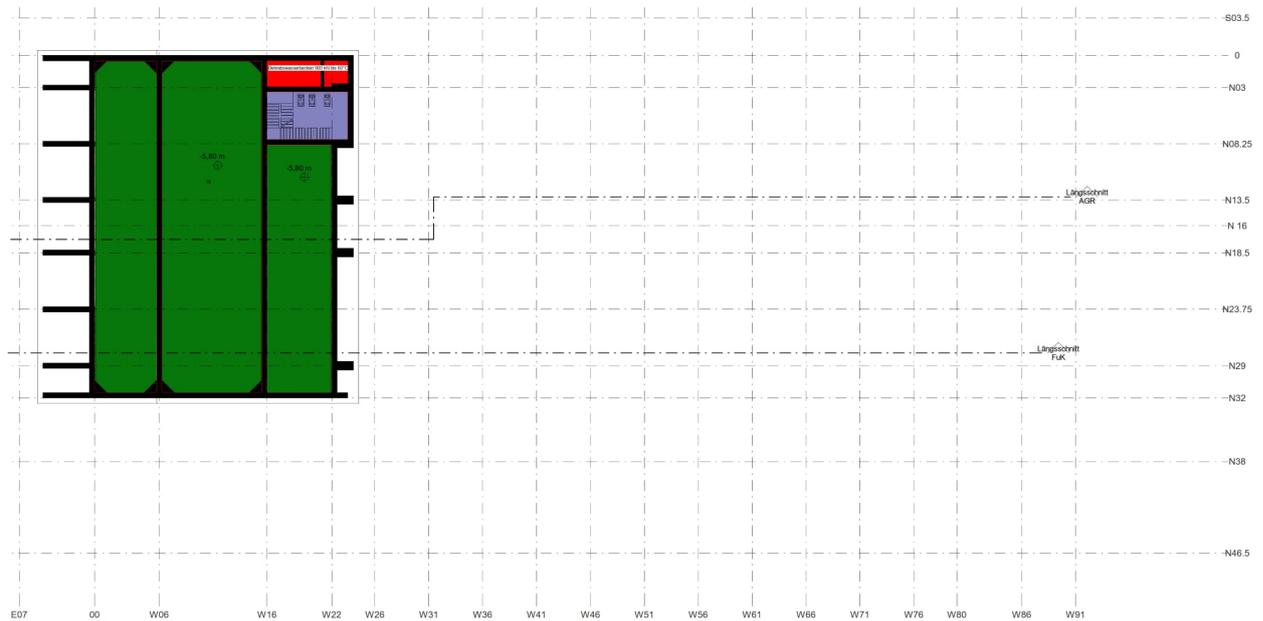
Nutzlasten Grundriss -6.00m
